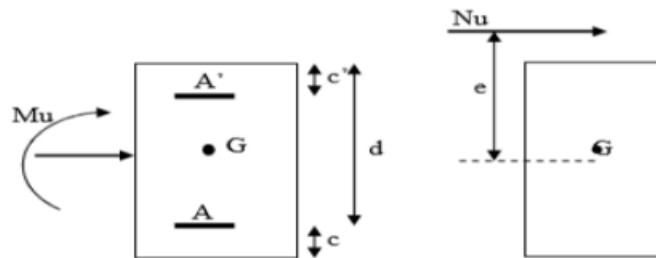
section partiellement comprimée (S.P.C).
